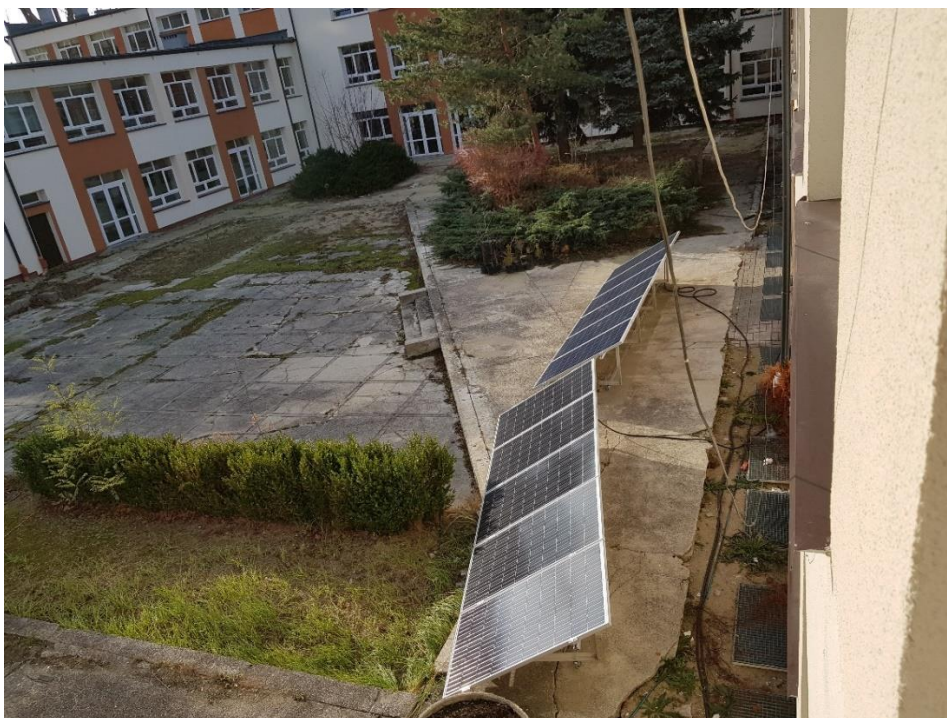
Widok w kier. elewacji północnej. W oddali widoczna rabata wyniesiona obramowana przez płyty oporowe betonowe. Dorosłe okazy drzew (świerki i sosna). Wejścia do budynku oznaczone kolorem na elewacji od prawej: W1 i W2
